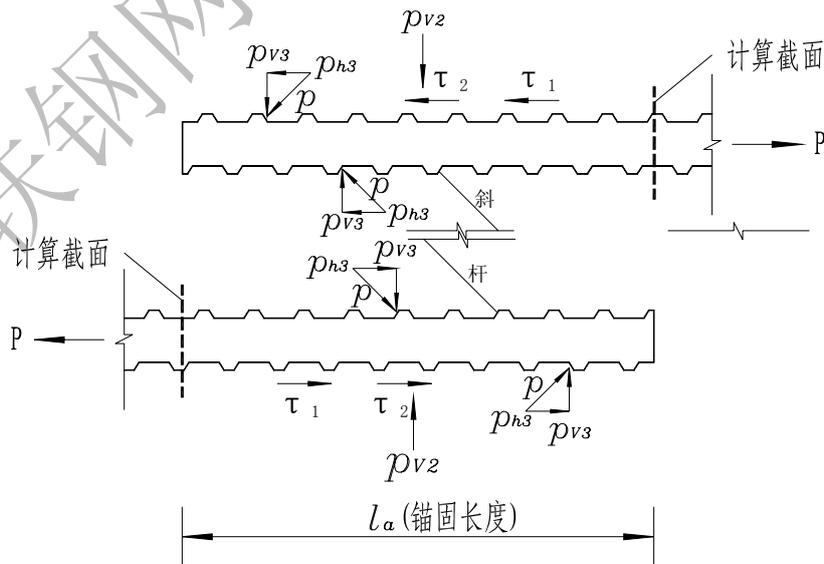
2 钢筋焊接网钢筋搭接机制
